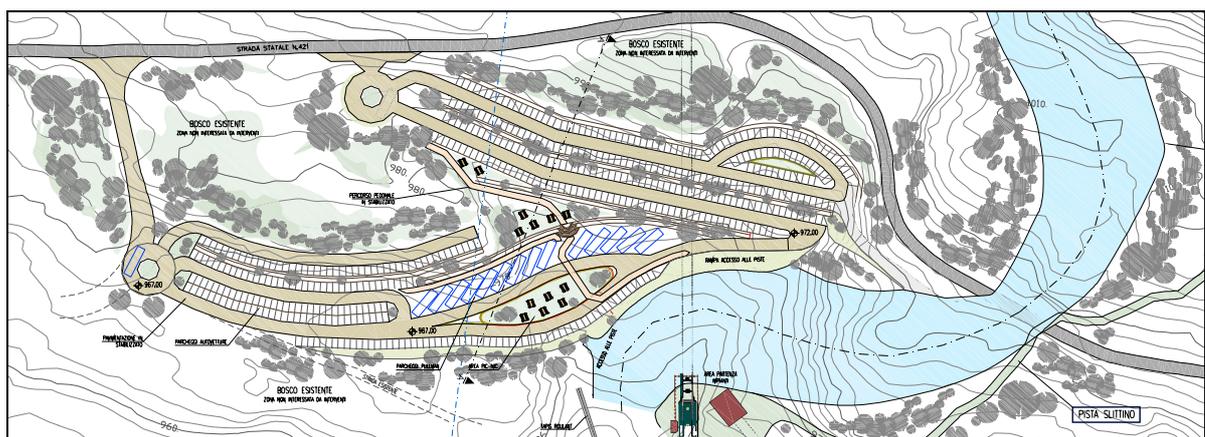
planimetria di progetto del parcheggio Genzianella
